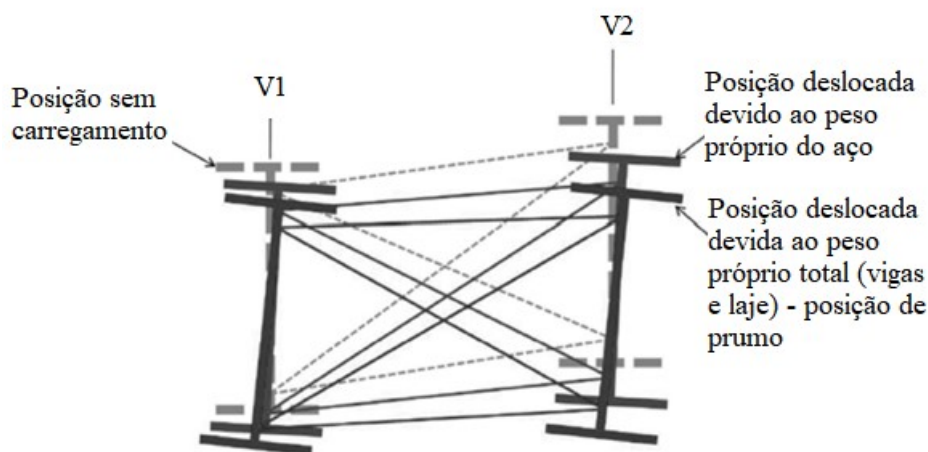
10: Posições das vigas e do contraventamento detalhadas para seu posicionamento.
